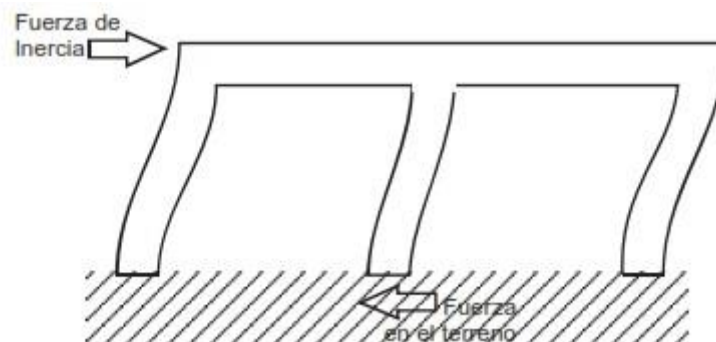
Sistema resistente de poca rigidez lateral. Fuente: Retrofitting Design of Building Structures, Xilin Lu (2010).
